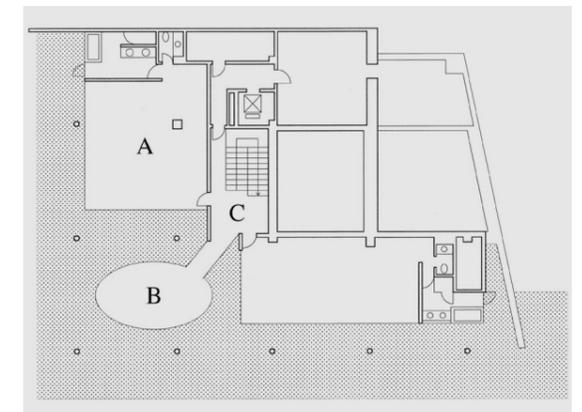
Planta baixa Water/Glass Pavillion. Fonte: Architecture Words 2: Anti-Object (2012).
